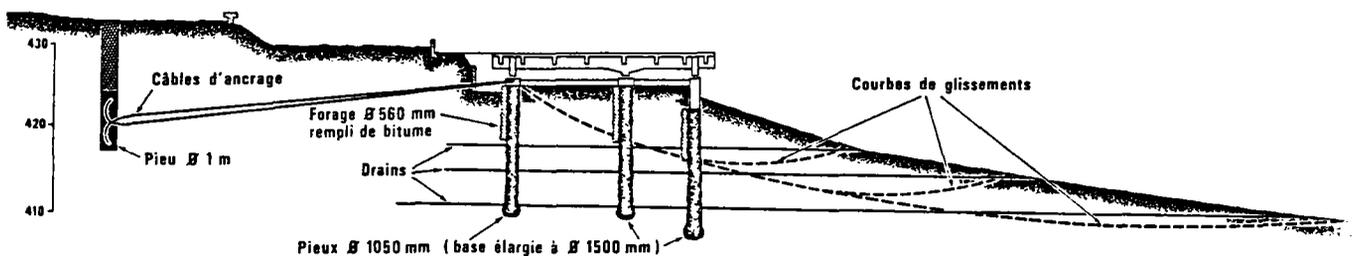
Ancrage par tirants précontraints d'une plate-forme fondée sur un glissement de terrain.
